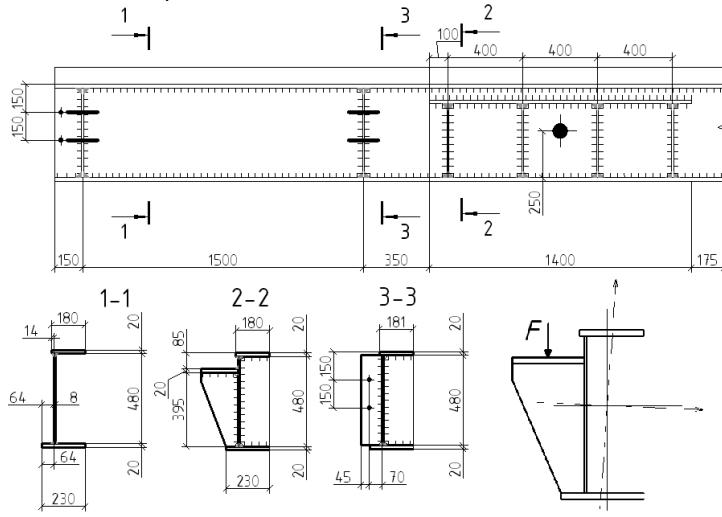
Креслення сталезалізобетонного ригеля та переріз ригеля із нанесеними головними осями та місцем прикладення зовнішньої сили
